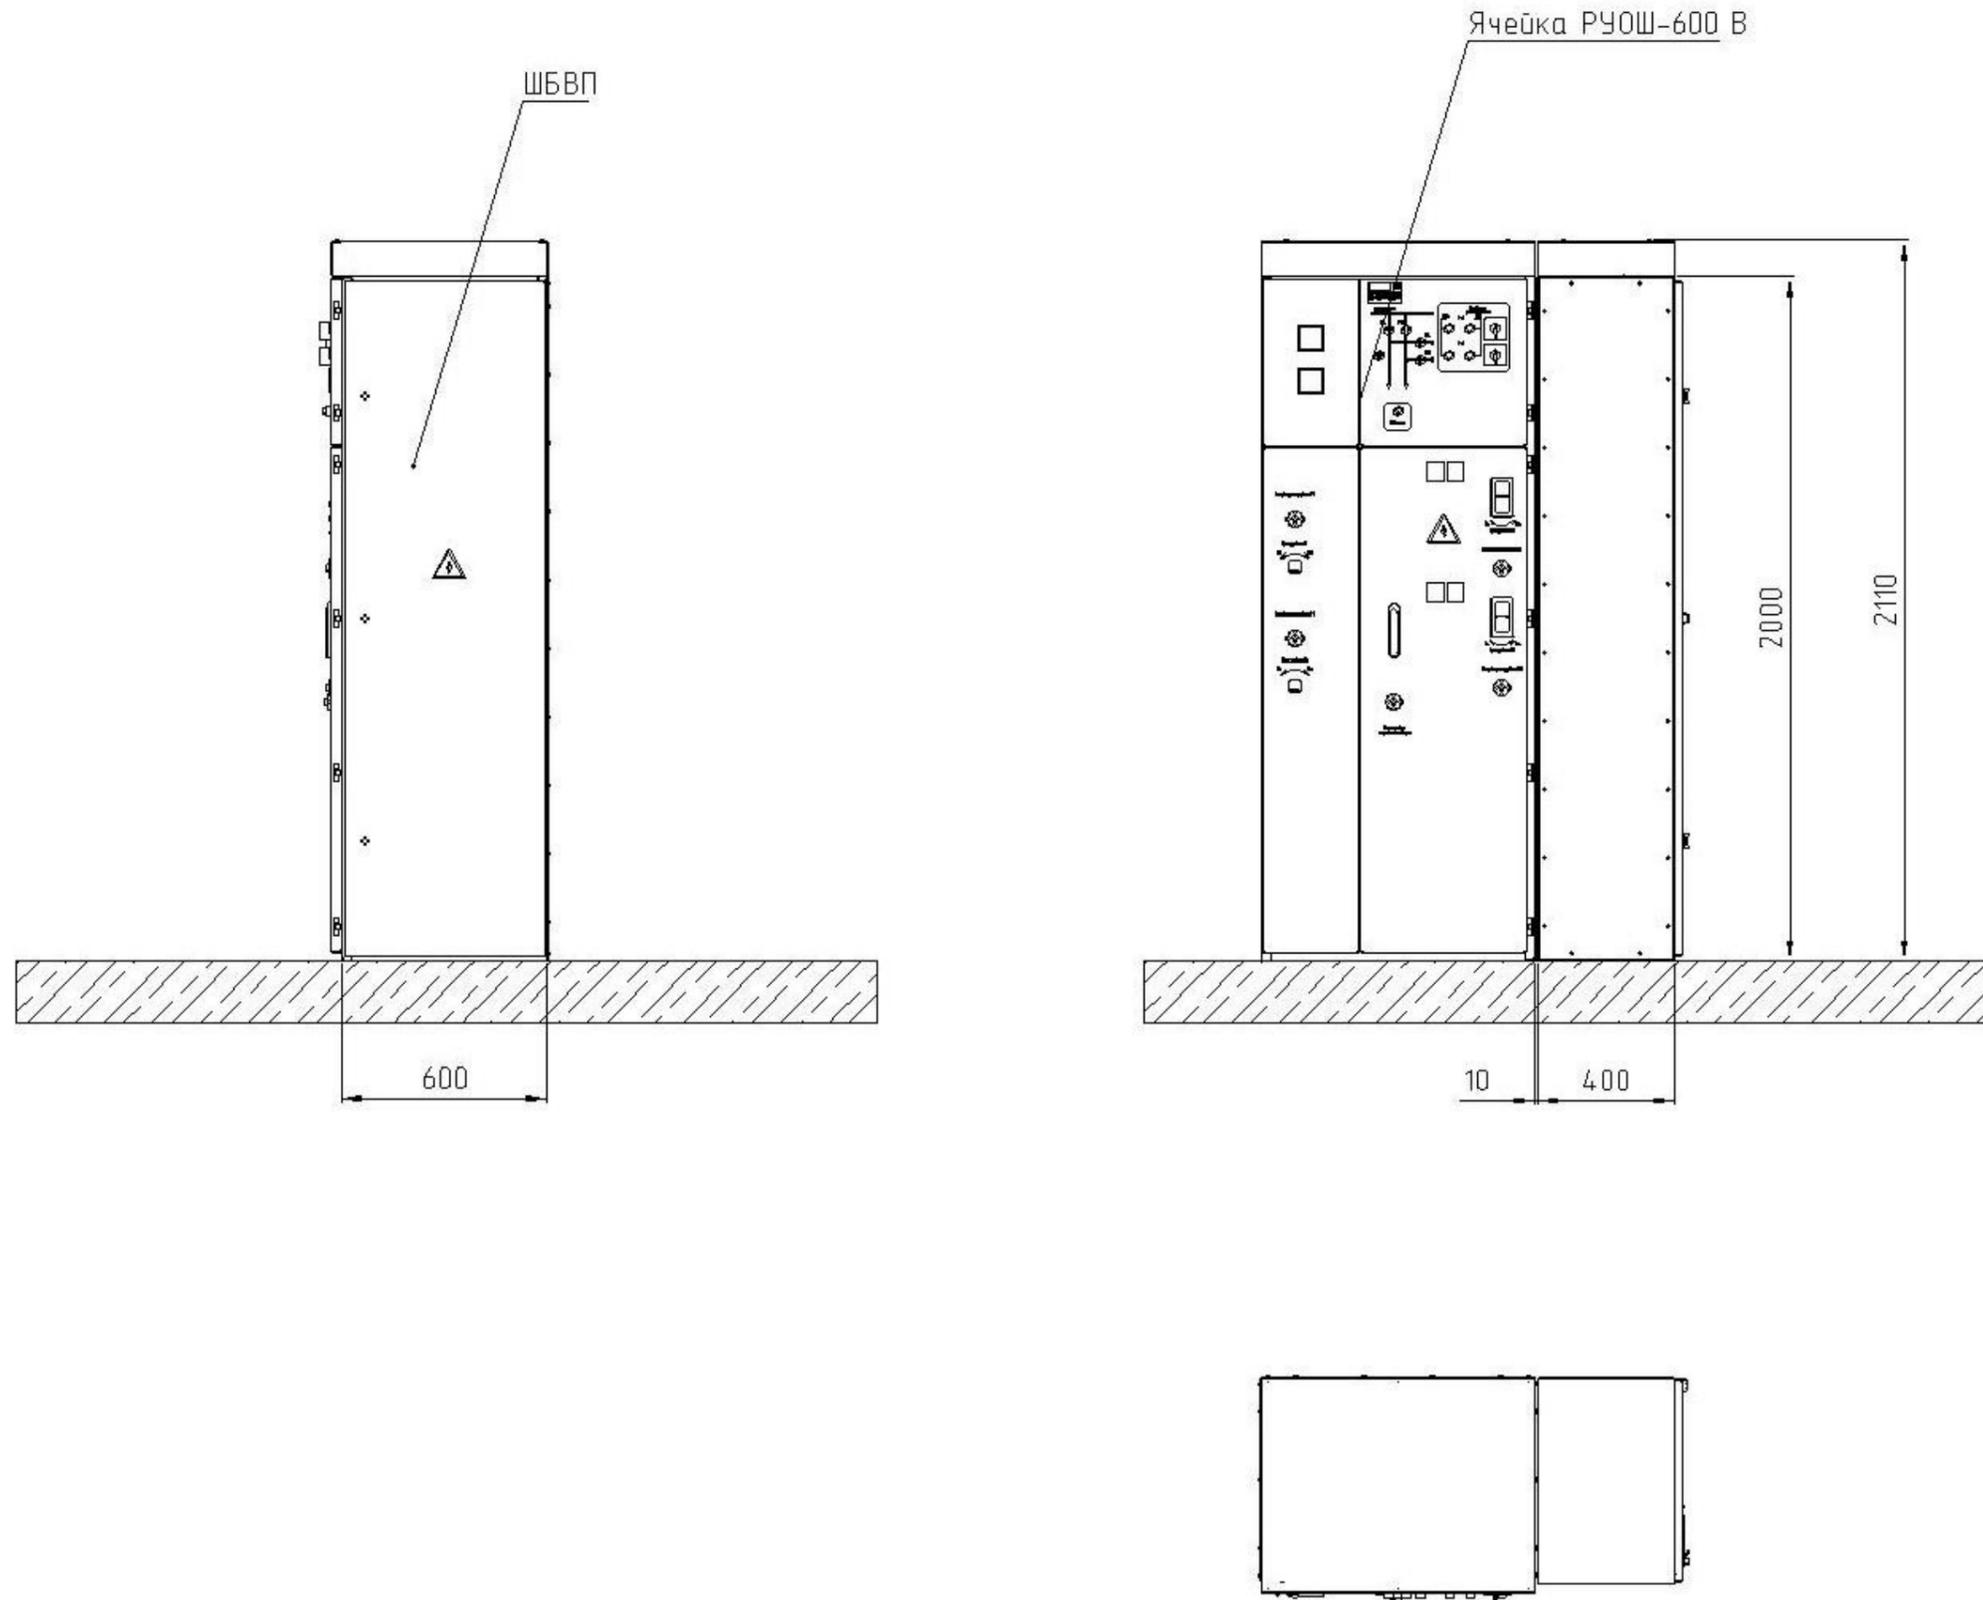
Установка ШБВП для РУОШ-600 В
